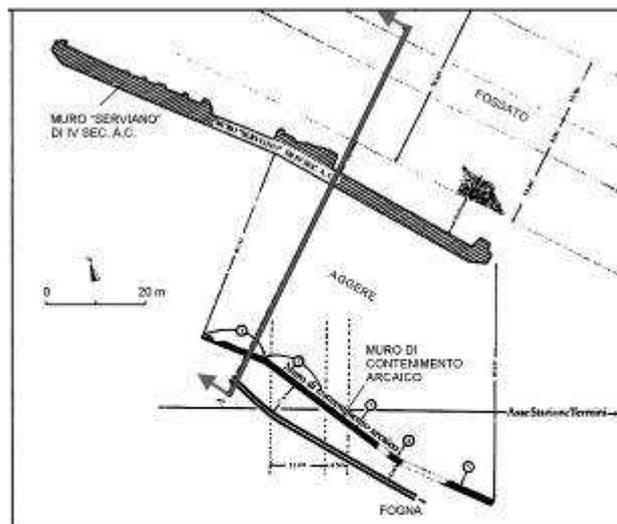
"Mura Serviane". Tratto sull'Esquilino presso la Stazione Termini. Pianta e sezione trasversale del fossato, dell'aggere medio repubblicano e del muro di contenimento arcaico (CIFANI 2008, rielab. dell'autore)
